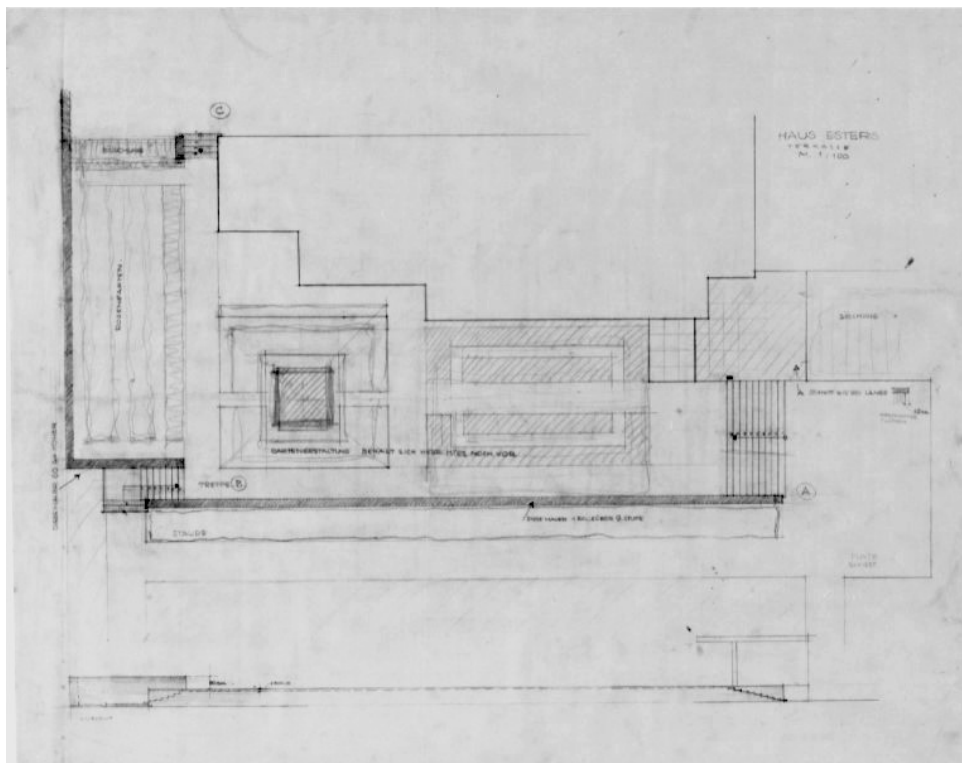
Planta baixa área externa, Casa Esters, 1927.
